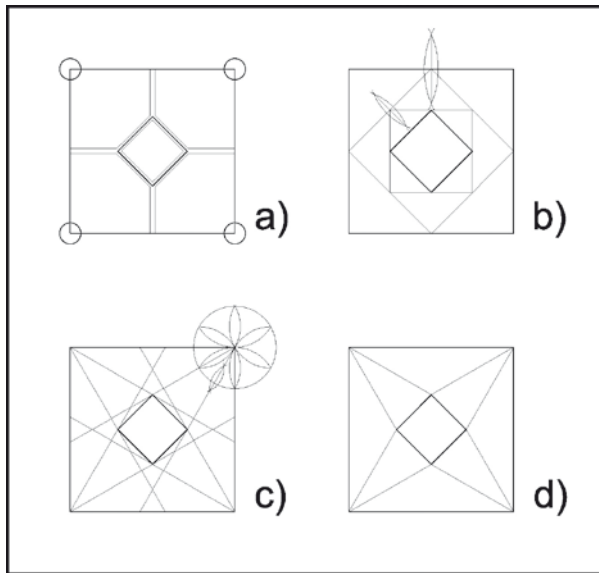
Pavimento de la Lonja de Valencia: a) Despiece del pavimento b) Trazado usando la plantilla de cuadrados c) Trazado basado en la división de la bóveda estrellada d) Bóveda estrellada con losange central.
